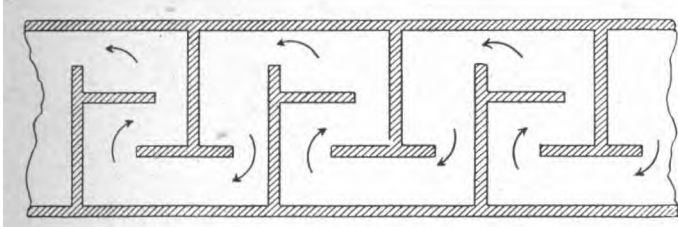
Échelle à poissons Brackett vue en plan.
